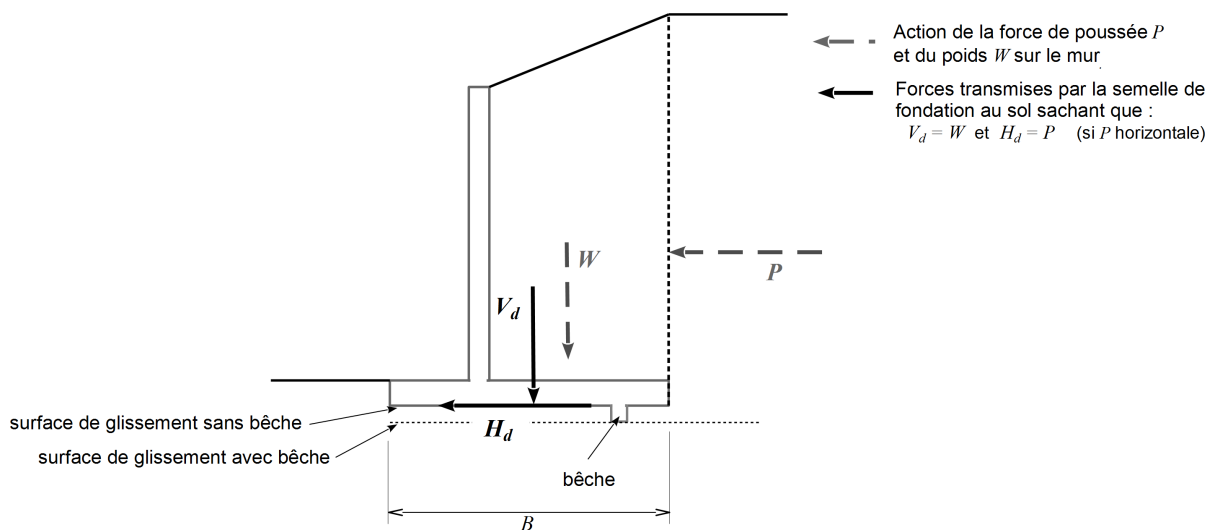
Forces normale et tangentielle s'appliquant sur le plan de glissement à l'interface entre la fondation du mur et sol.
